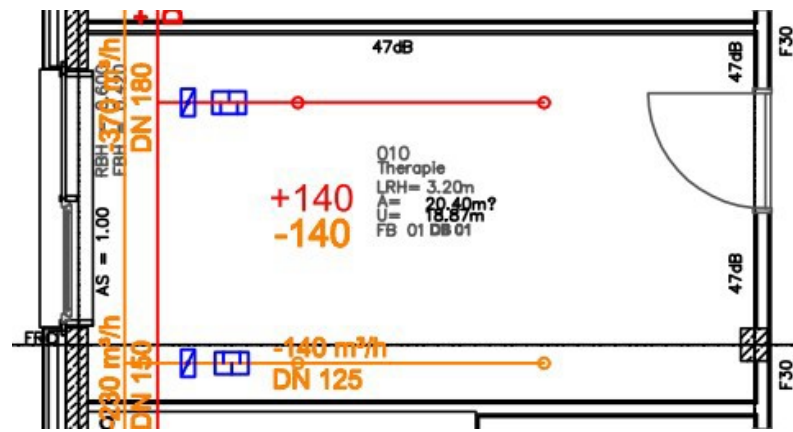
Ausschnitt aus dem Lüftungsgrundriss (Therapieraum)
